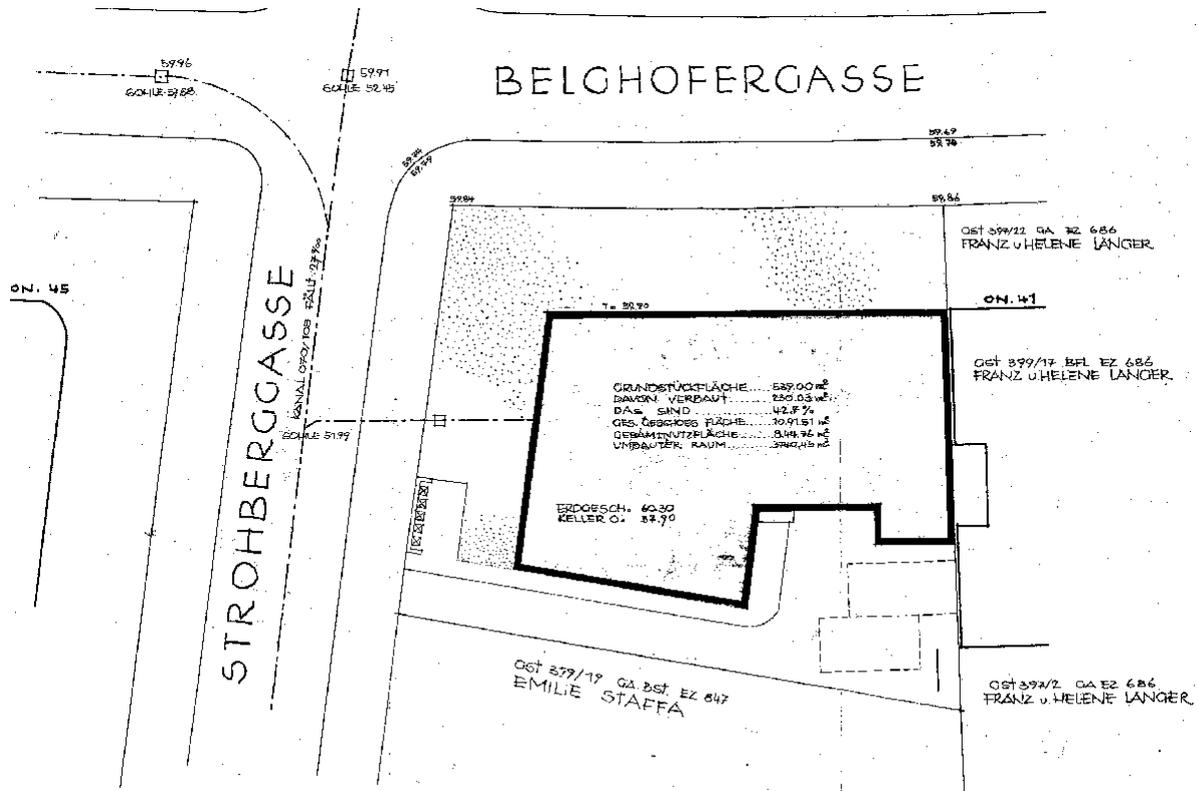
Lageplan Belghofergasse [Quelle unbekannt]
